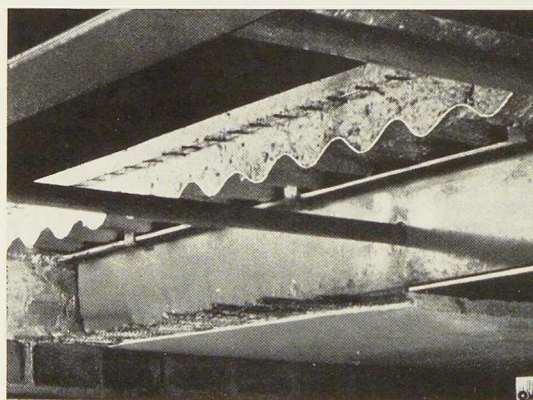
Type de ciel d'abri équipant un sous-sol. Il est constitué par une couche de béton coulée sur de la tôle ondulée prenant appui sur des poutrelles.
